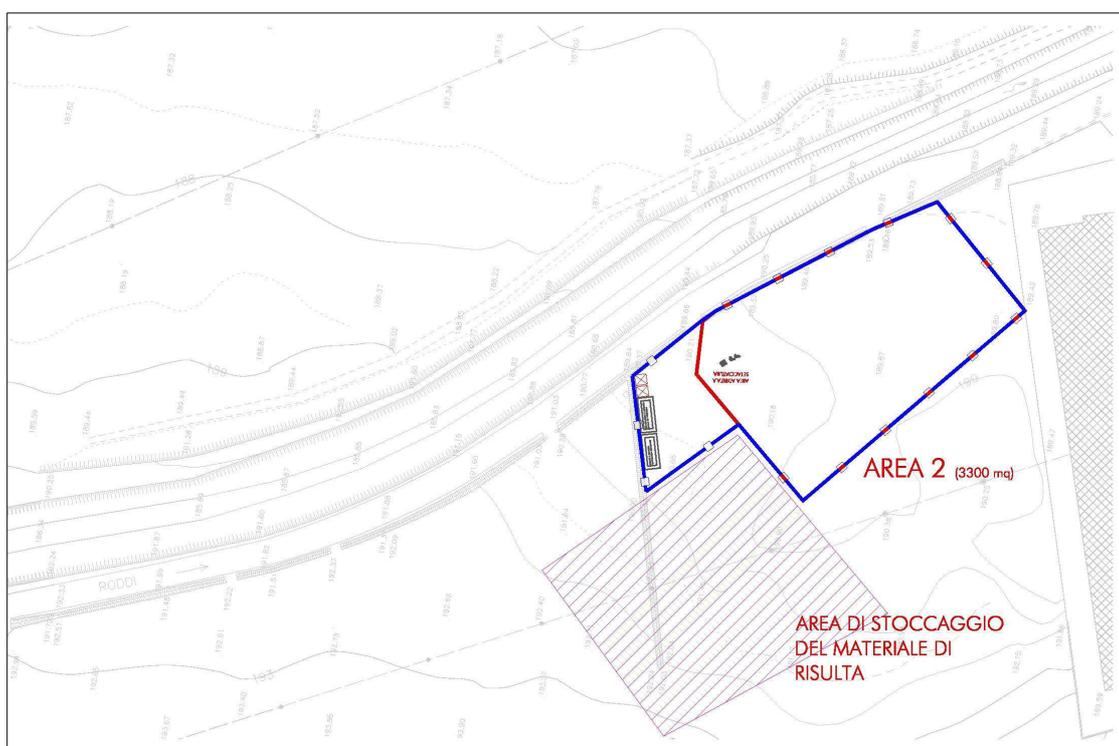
Planimetria della seconda fase di indagine – Area 2
